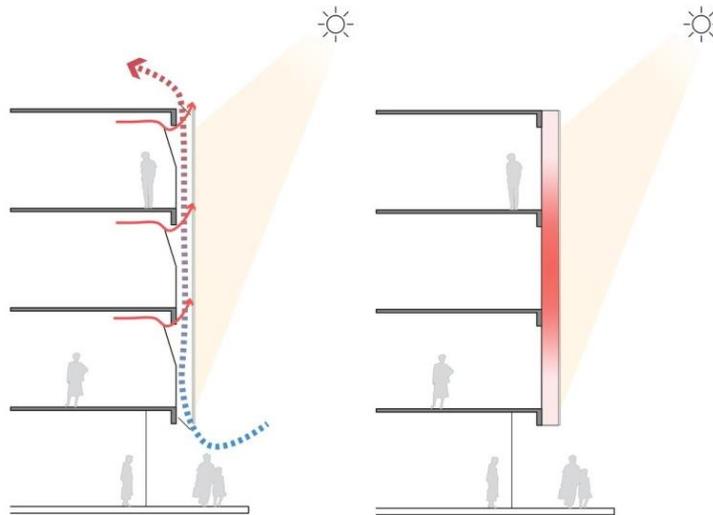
Propuesta para ventilación por sistemas de doble fachada
